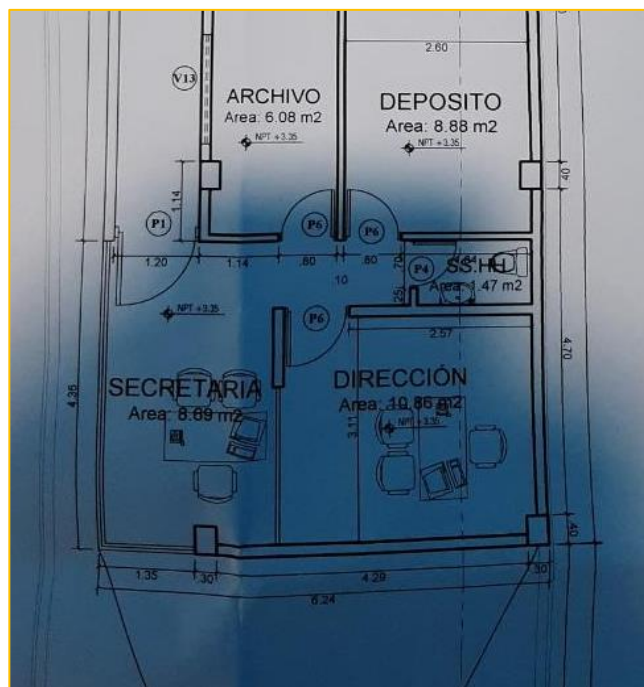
Plano de arquitectura, ambientes de secretaría, dirección, depósito y archivo en el segundo nivel.
